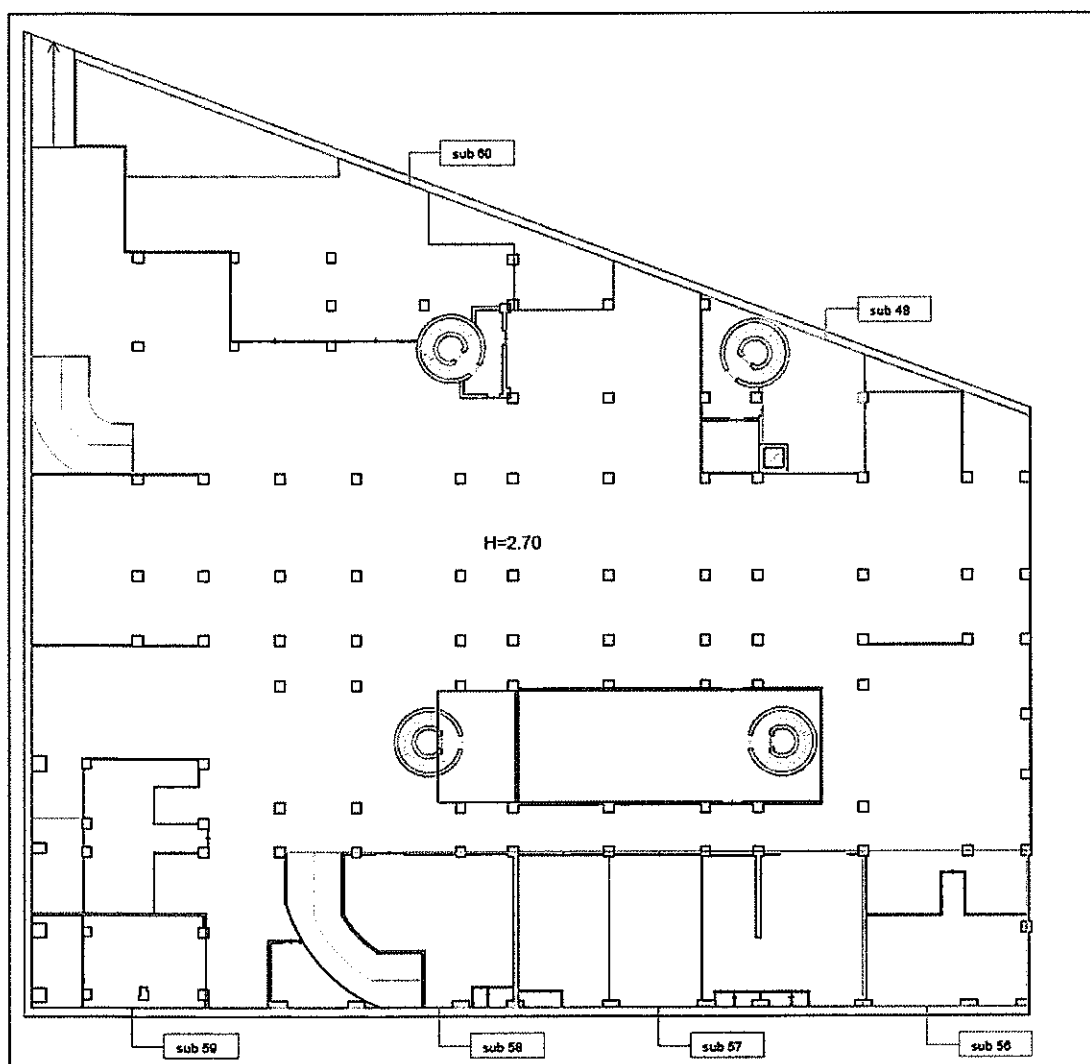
Rilievo planimetrico del piano secondo interrato (in grigio le porzioni comuni e/o di proprietà aliena), i depositi distinti con i sub 56, 57, 58 e 59 sono, invece, individuati singolarmente.
